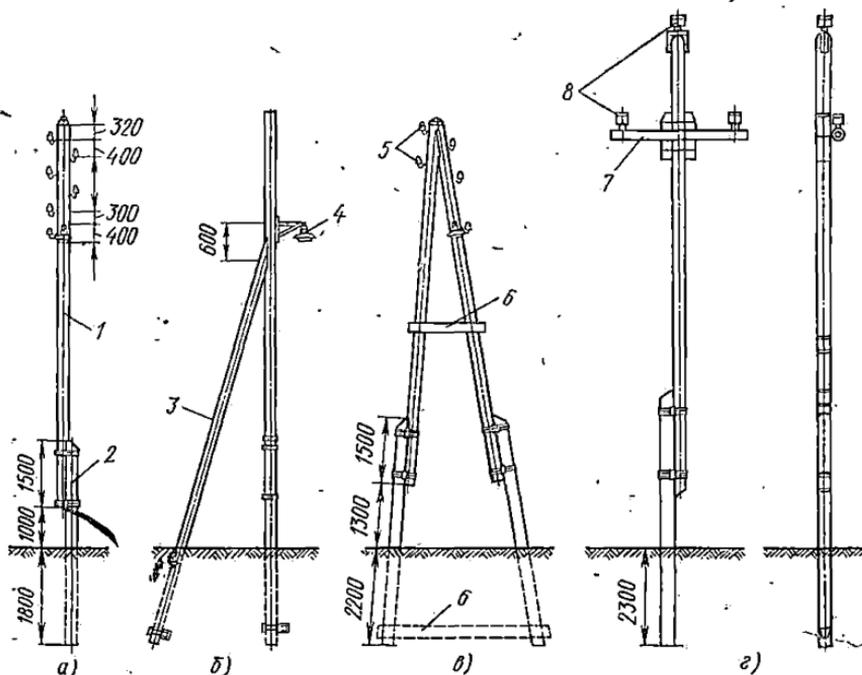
Конструкции деревянных опор ВЛ напряжением до 10 кВ:
